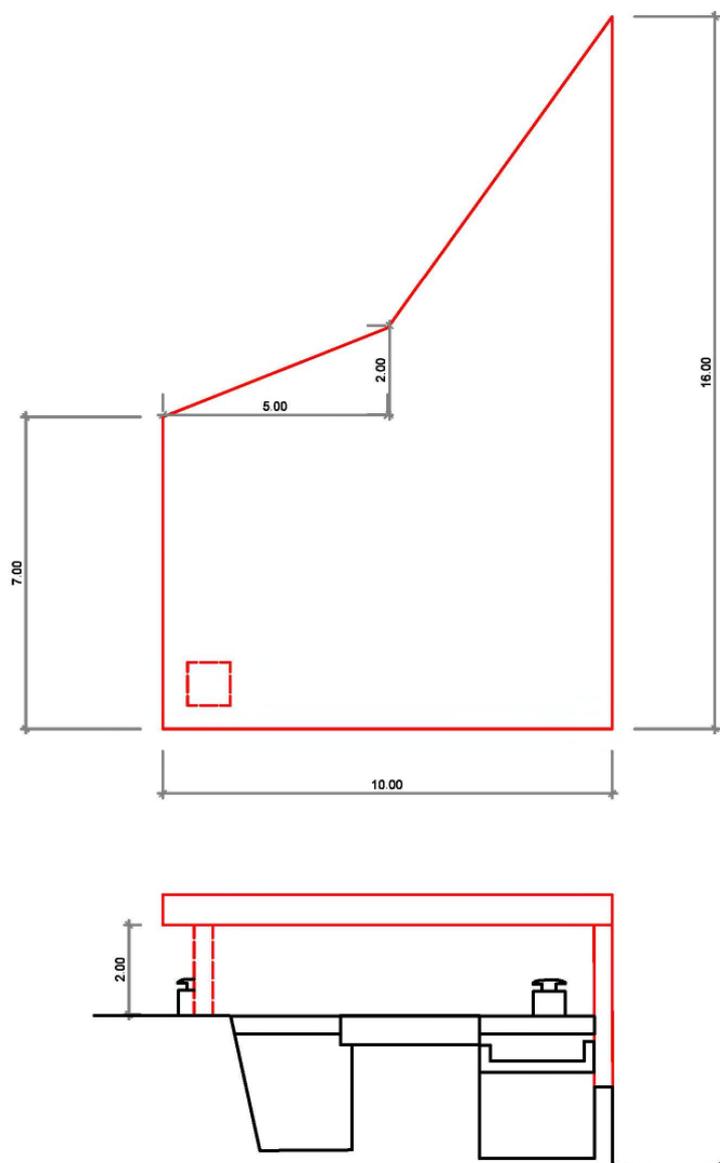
Soletta di copertura della captazione – Pianta e vista indicative
